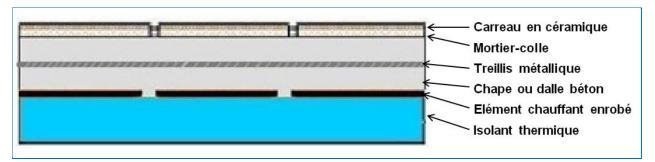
Mode de pose type 1 : Vue en coupe du plancher chauffant intégré dans la chape ou dalle
